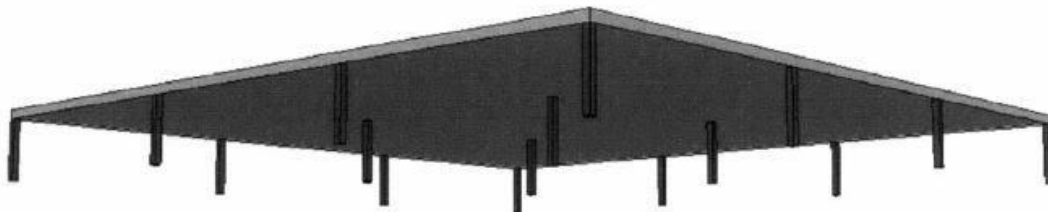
3D модель рассчитываемой плиты перекрытия
